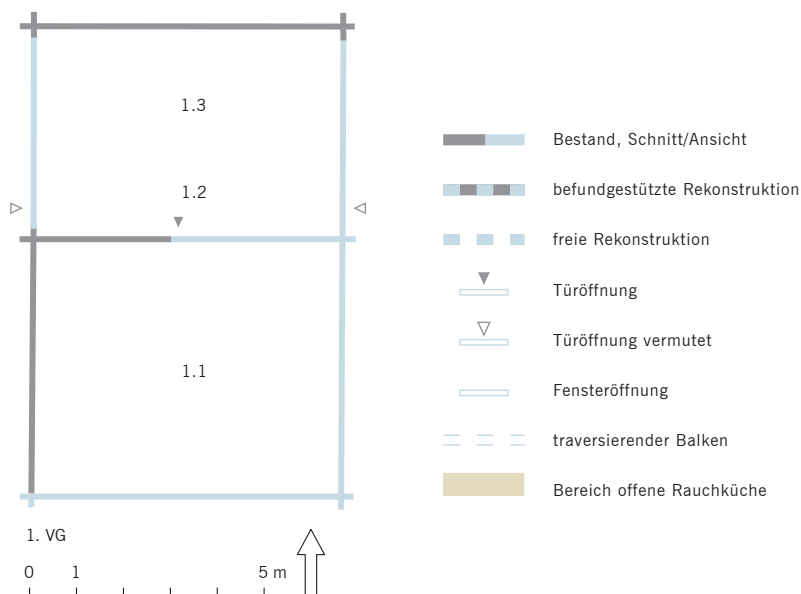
Haus Blumenweg 4 in Menzingen, rekonstruierter Grundriss des Gründungsbaus.
